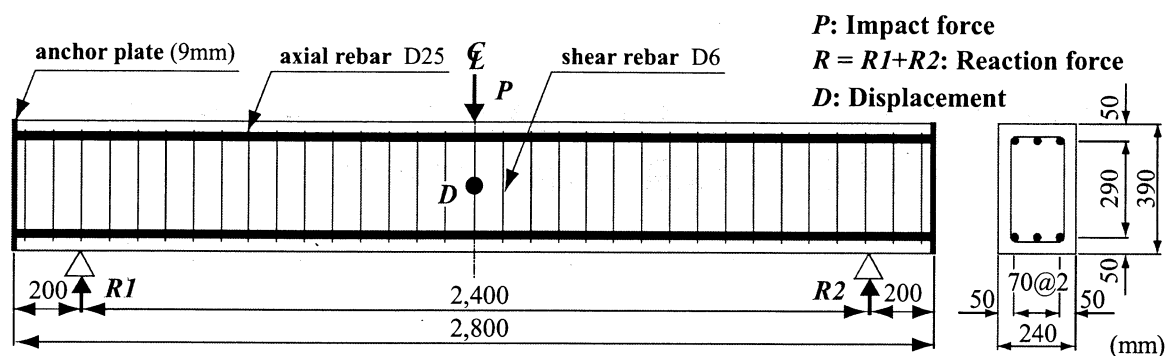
試験体の形状寸法および配筋状況 (例: S85 梁)
